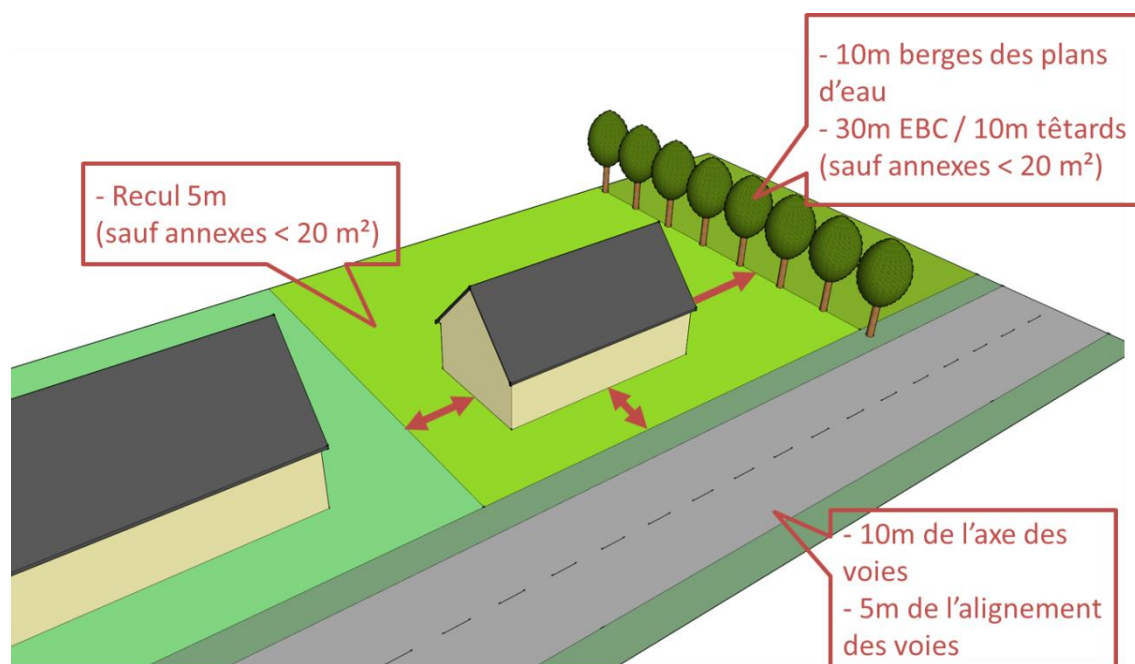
Implantation des constructions dans le secteur Ud (hameaux)
